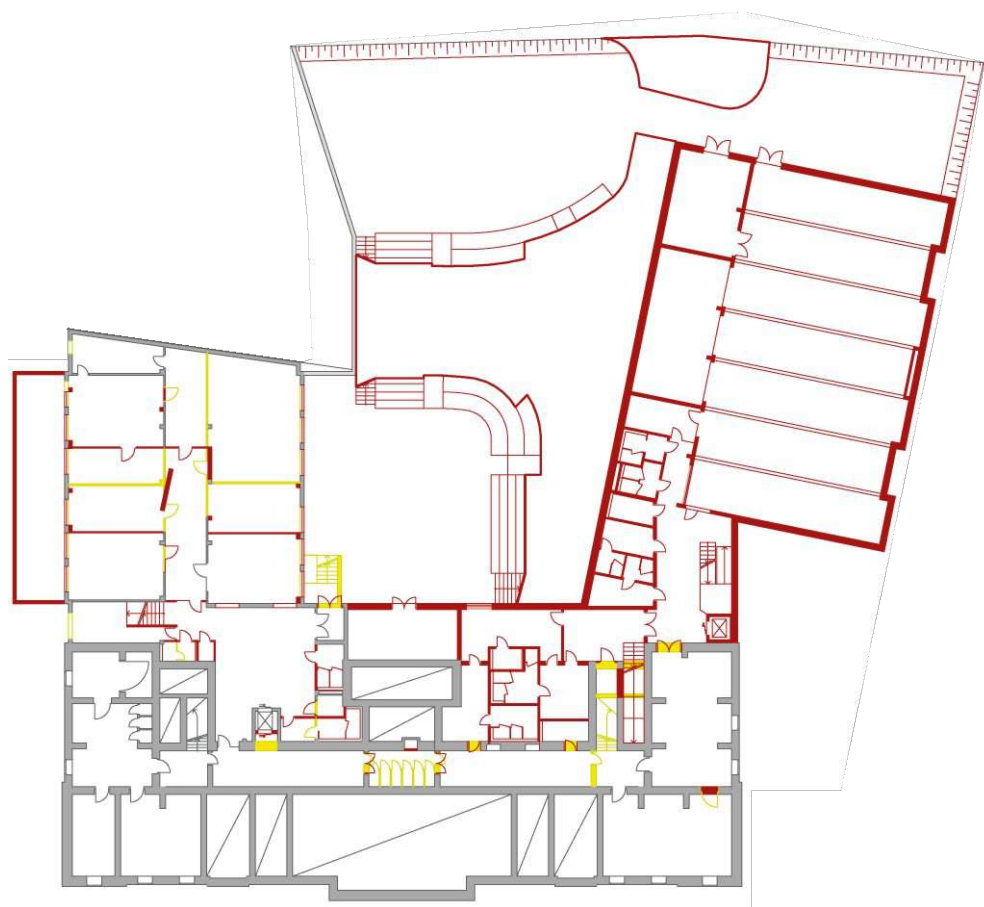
Rot-Gelb Plan: Gartengeschoß.
